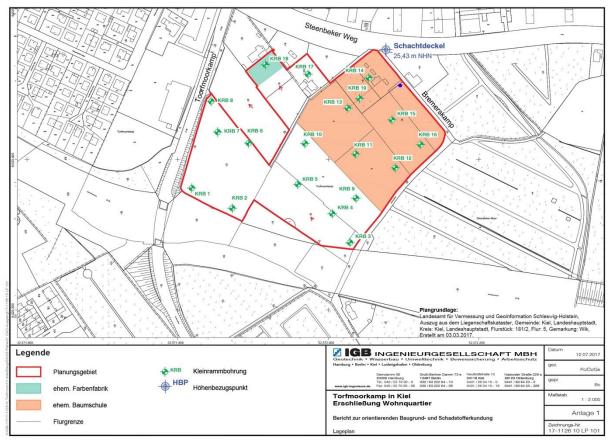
Untersuchungsgebiet mit Kennzeichnung der Kleinrammbohrungen und der Altlastenverdachtsflächen.
